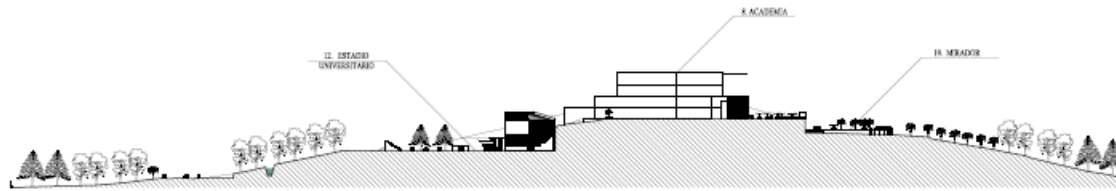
Implantación de Plan Masa Campus Guano Unach.
